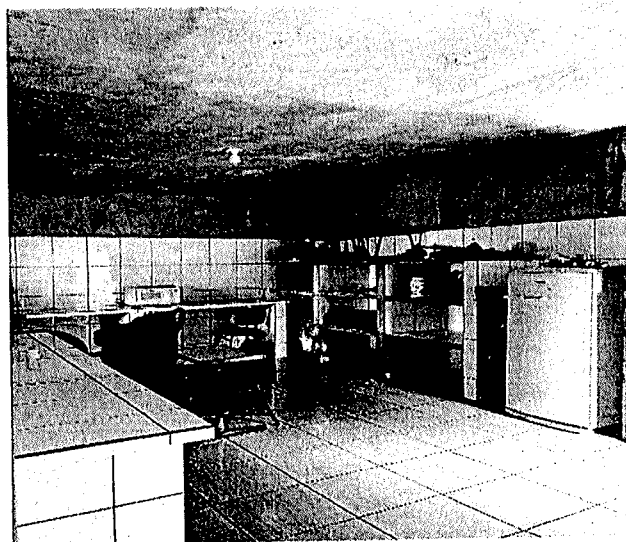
O ambiente apresenta paredes executadas em alvenaria, com revestimento cerâmico aplicado em aproximadamente 2/3 da altura, enquanto a faixa superior é apenas rebocada e sem pintura, o piso é totalmente revestido com placas cerâmicas, assentadas em padrão retangular. O teto é constituído por laje maciça com acabamento apenas em reboco. O espaço conta ainda com bancada em alvenaria revestida com cerâmica, além de prateleiras também em alvenaria e cerâmica fixadas às paredes.
